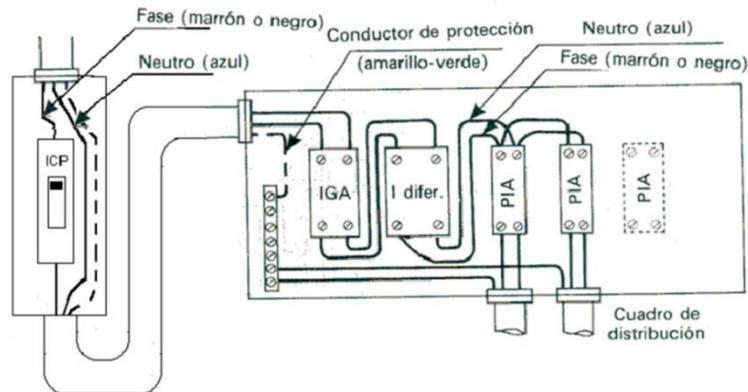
Esquema del dispositivo general de mando y protección
